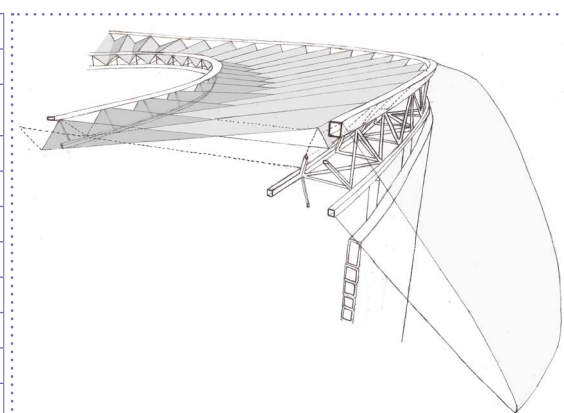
Aspecto exterior de la cubierta del estadio Cívitas Metropolitano
